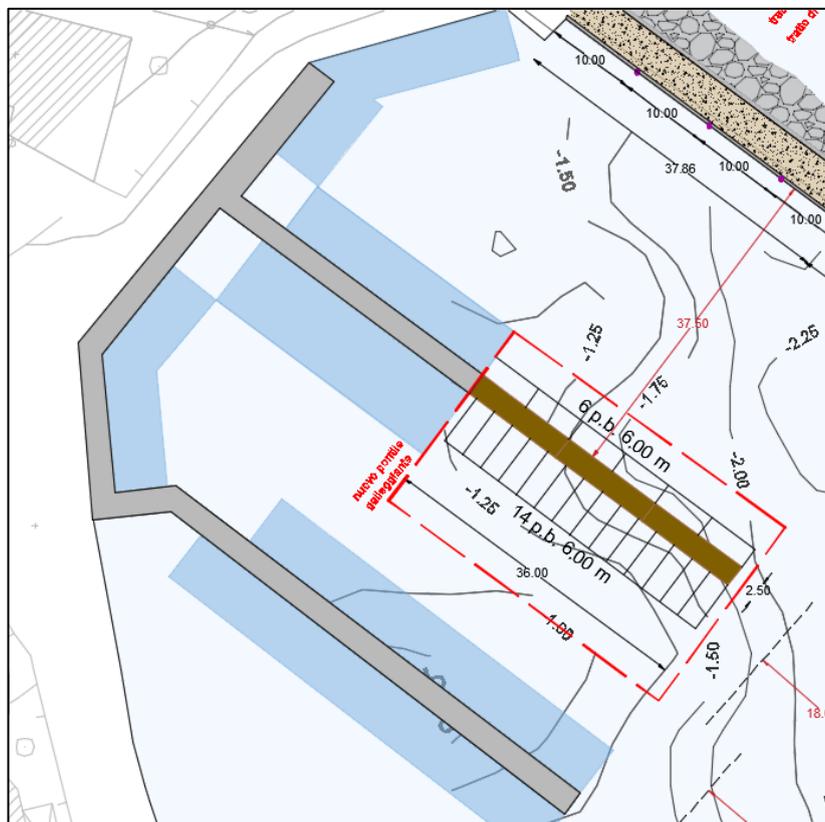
Stralcio planimetrico prolungamento pontile galleggiante
